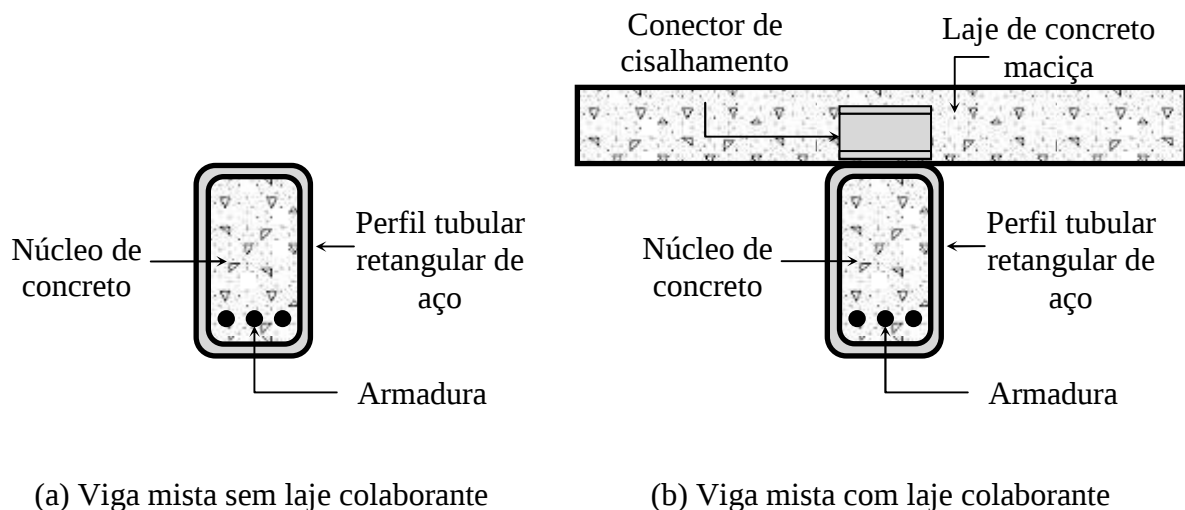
Vigas mistas tubulares de aço preenchidas com concreto
